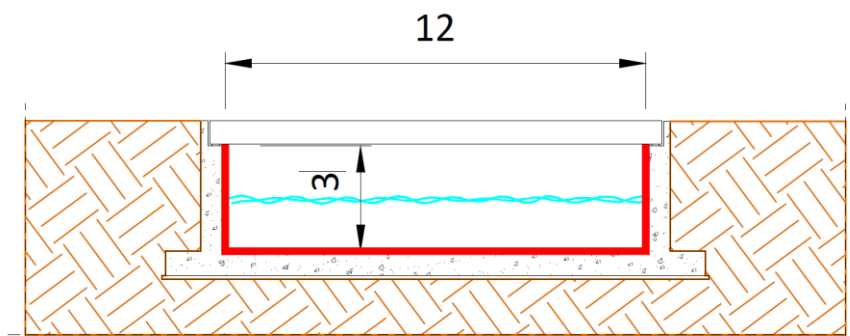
Nuova sezione di progetto scatolare ponti in c.a..
